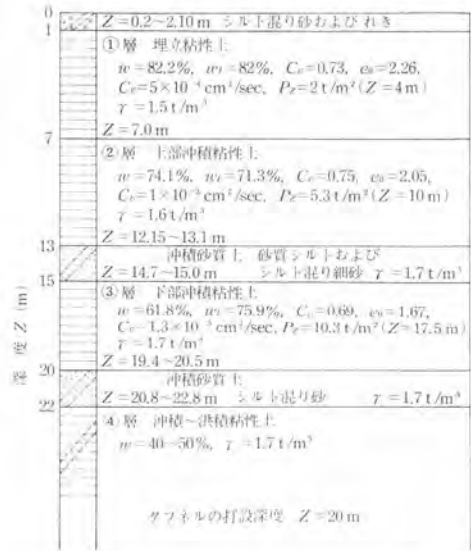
名古屋港流通センター地盤改良工事標準土層断面図
